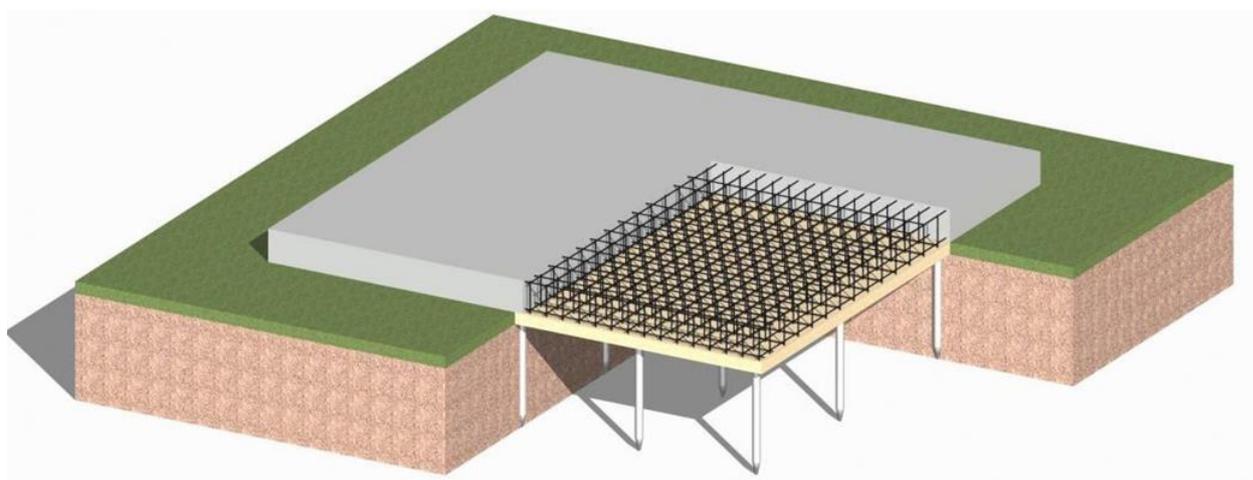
Свайно- плитный фундамент (ustanovkasvai.ru)
